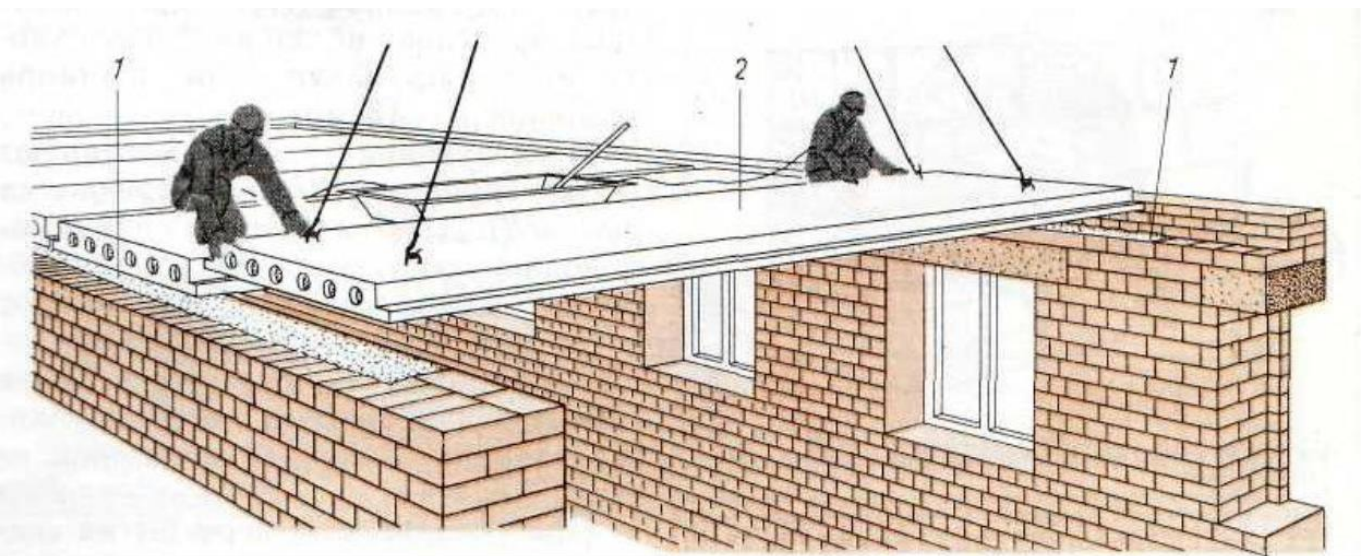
Укладання плит міжповерхового перекриття 1-ліжка розчину
